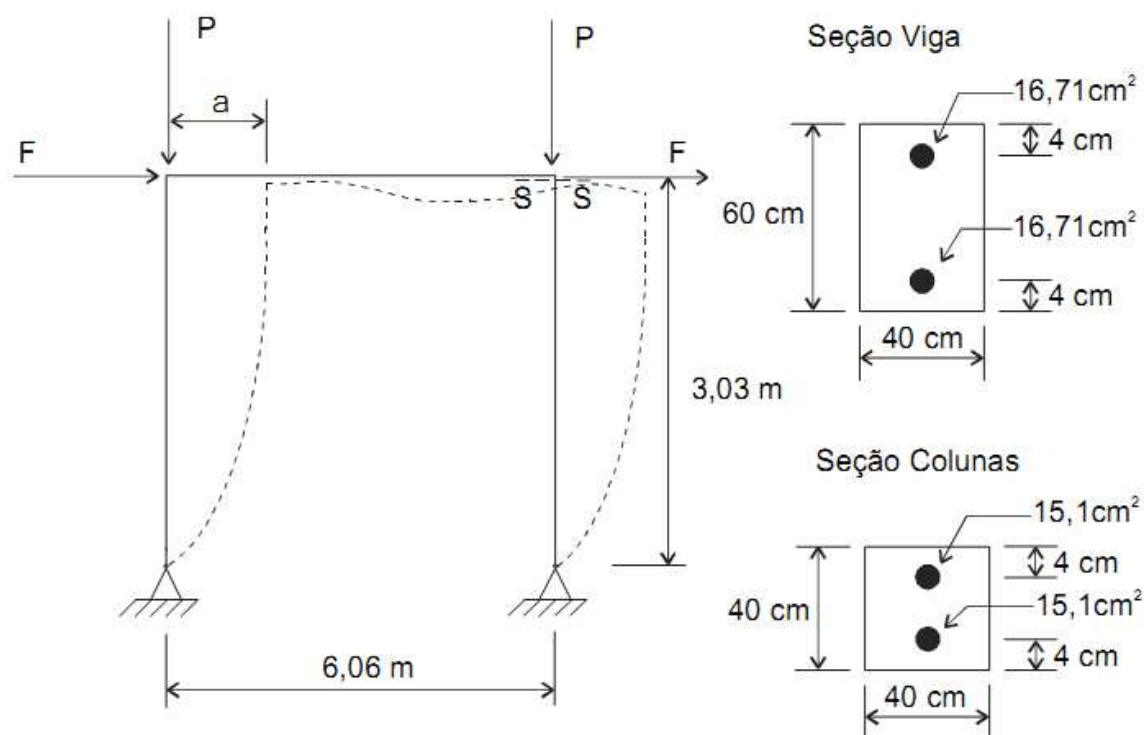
Pórtico exemplo para verificação da NLG e NLF (Fonte: Melo, 2000).
